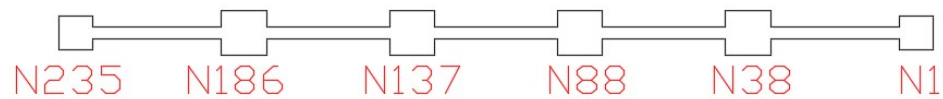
Vista en planta de los elementos de la cimentación con nombres de referencia
